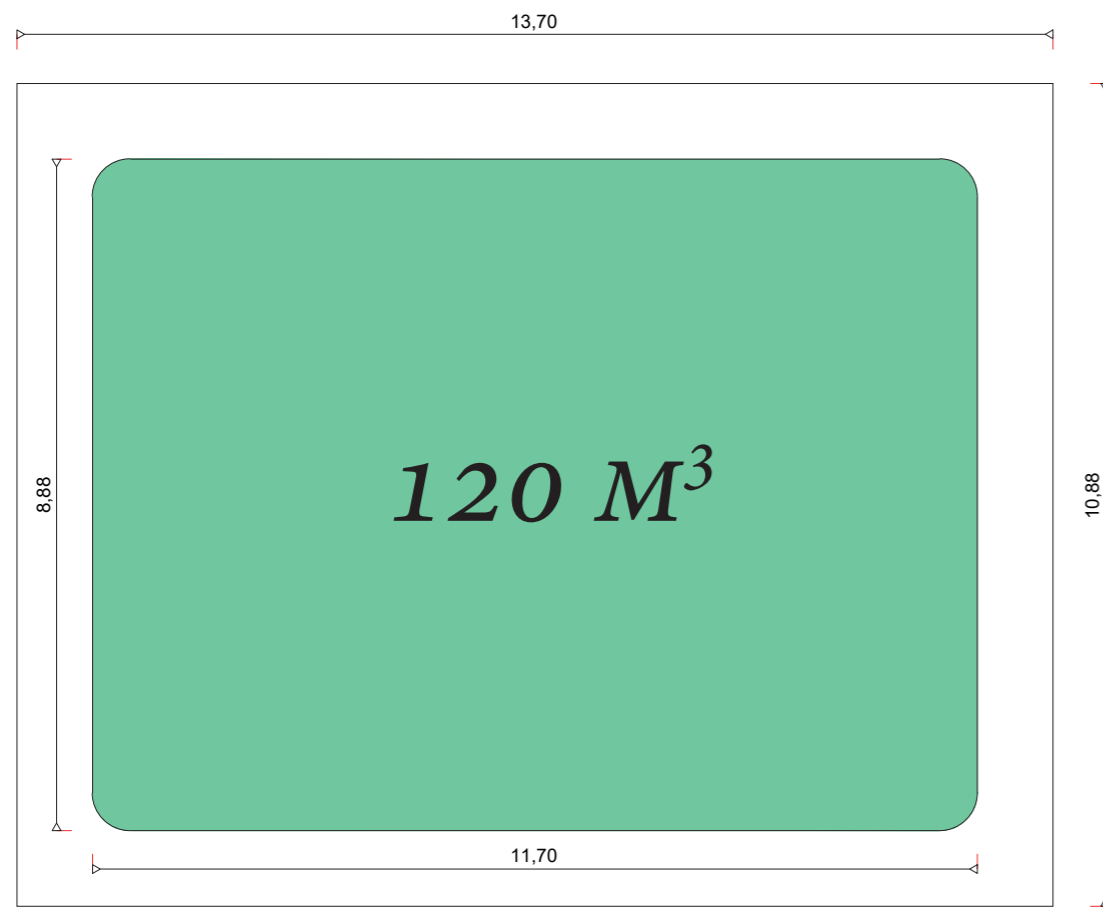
DETAILS - ÉLÉVATIONS DE LA CAMÉRA - échelle 1/40e
